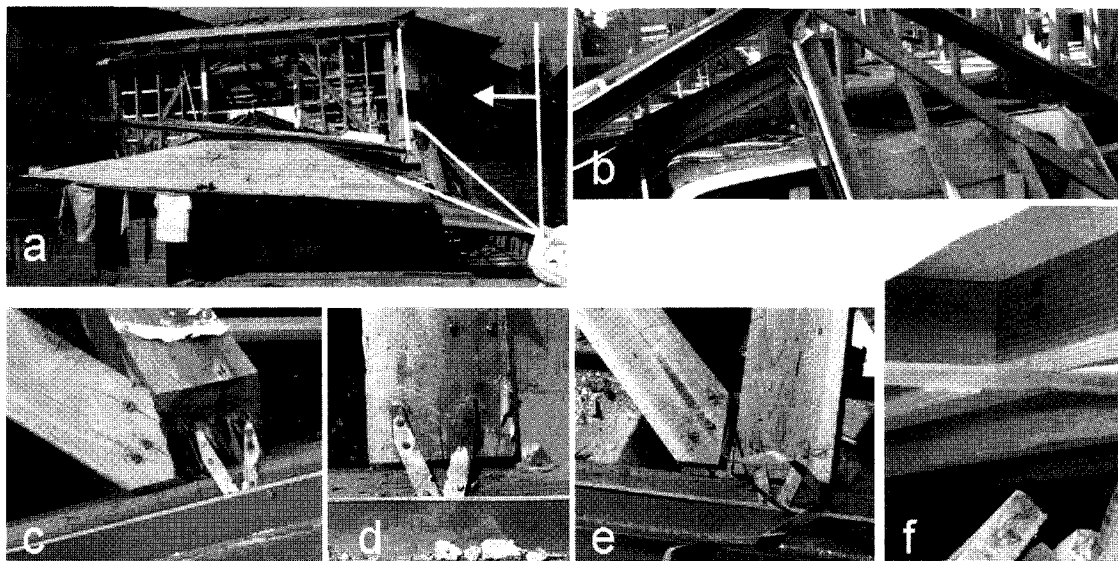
Exemple 1, comportement de la structure du rez-de-chaussée,
